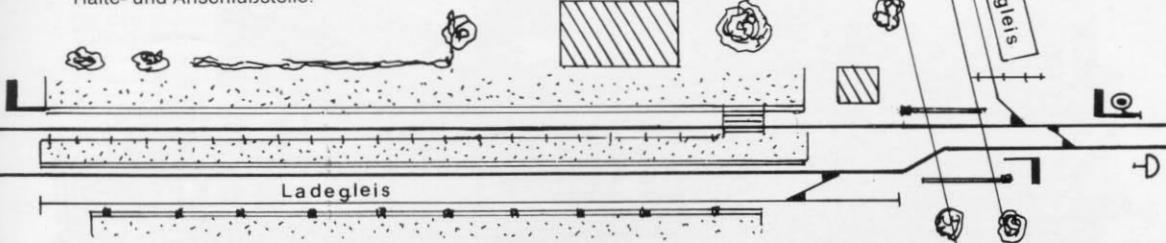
gibt eine typisch bayerische Haltestelle wieder. Hier war ein Haltepunkt mit einer dem öffentlichen Verkehr dienenden Anschlußstelle (Ladegleis und Rampe) verbunden. In der Praxis wurde diese recht „sparsam“ ausgestattete Bahnanlage sogar zum Kreuzen von Zügen benutzt, war also betrieblich eine „Ausweich-Anschlußstelle“. Ein VT 75 setzte nach erfolgter Abfertigung in das Ladegleis zurück und wartete die Durchfahrt eines aus der Gegenrichtung kommenden Eilzuges ab, der aus drei Schürzenwagen und einem Packwa-
